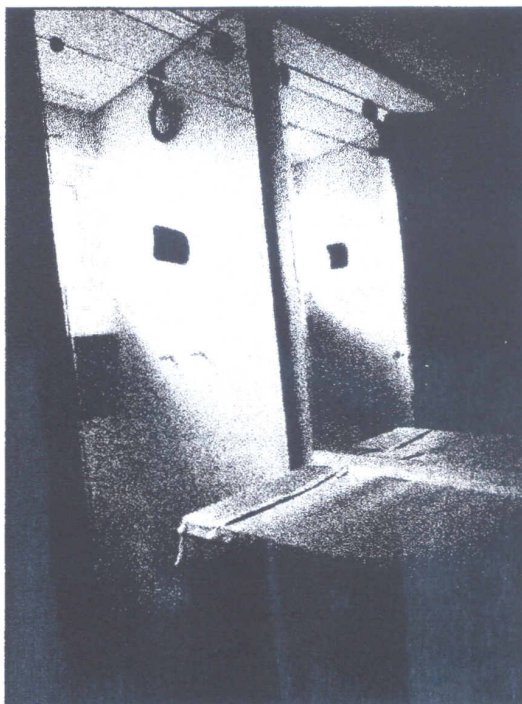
VISTA DO SANITÁRIO DA SUÍTE 01
